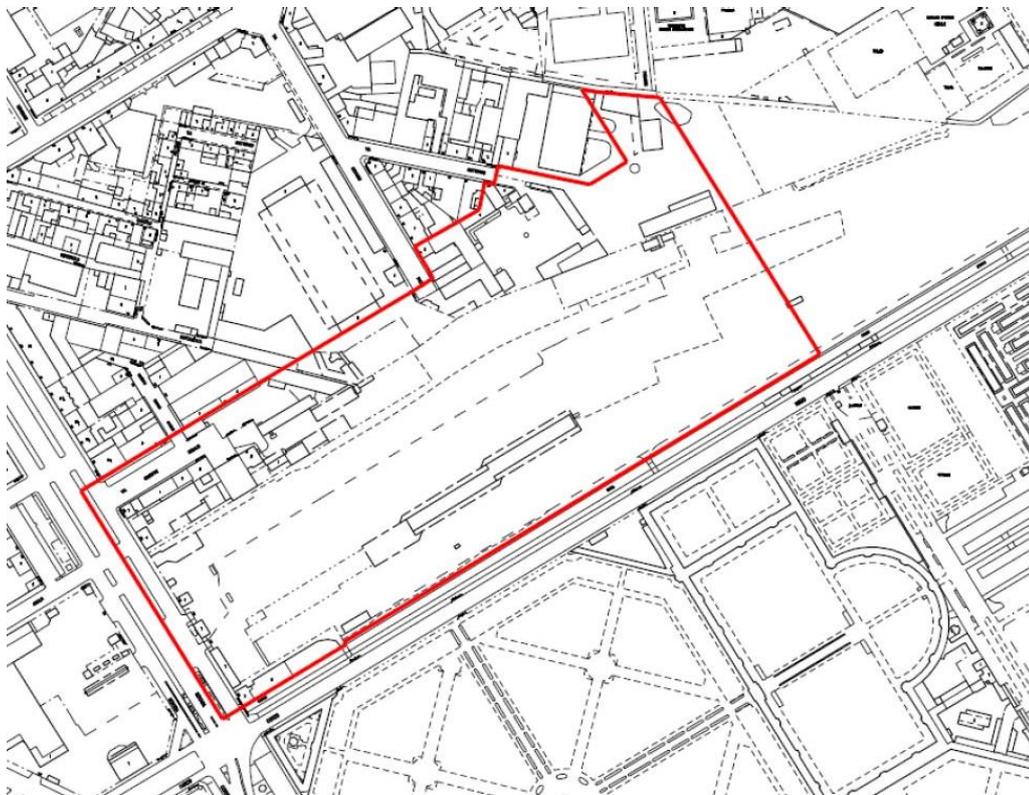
Pianta dell'area in esame (stato di fatto) con indicazione delle superfici interessate dall'intervento.
